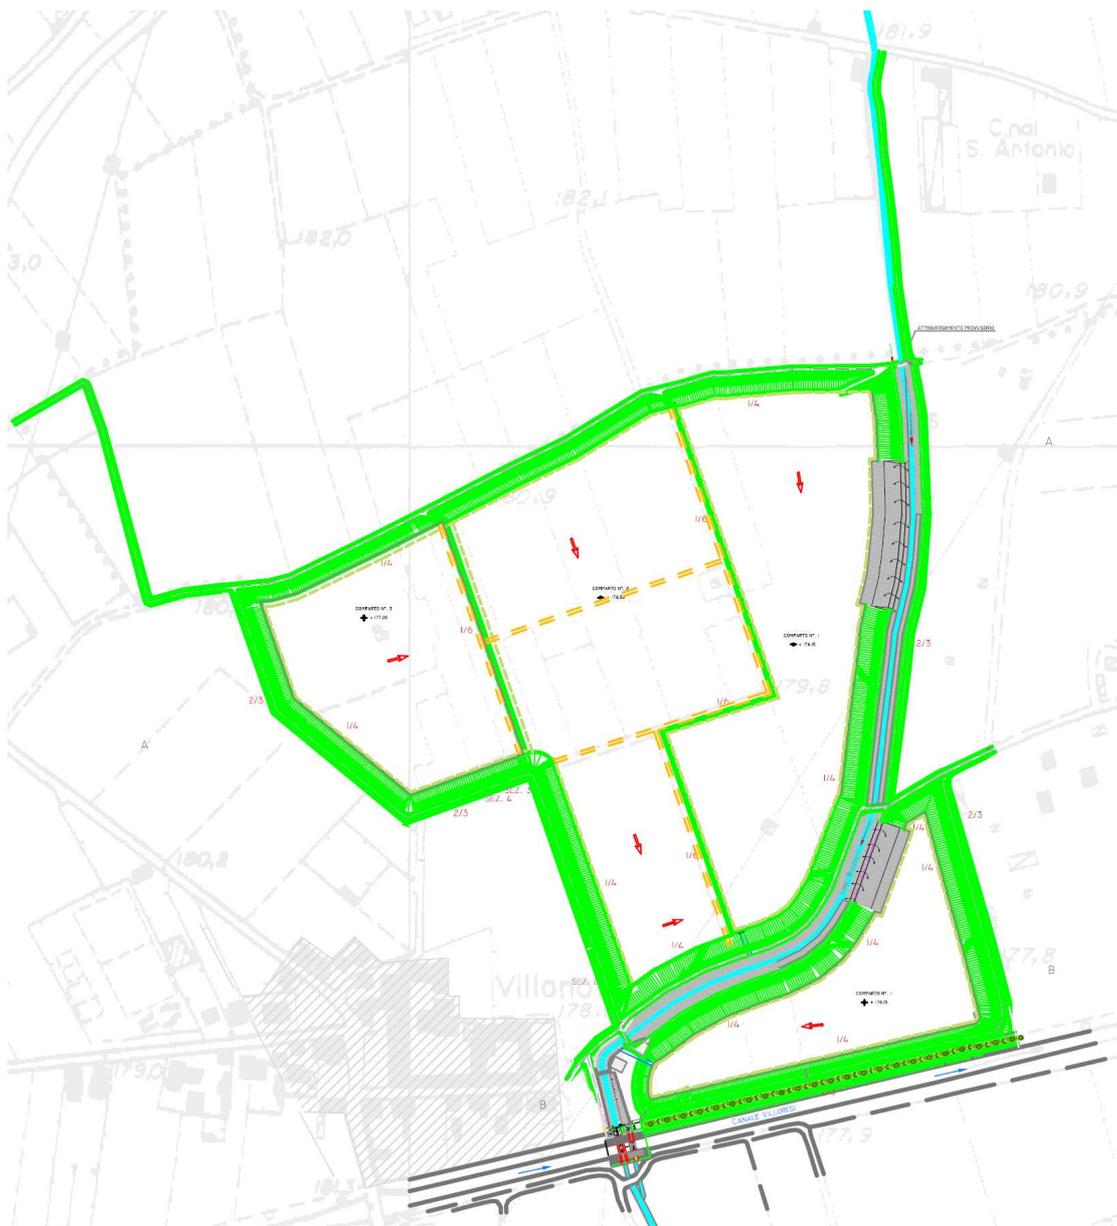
Planimetria dell'area di laminazione come da progetto definitivo ottobre 2013
